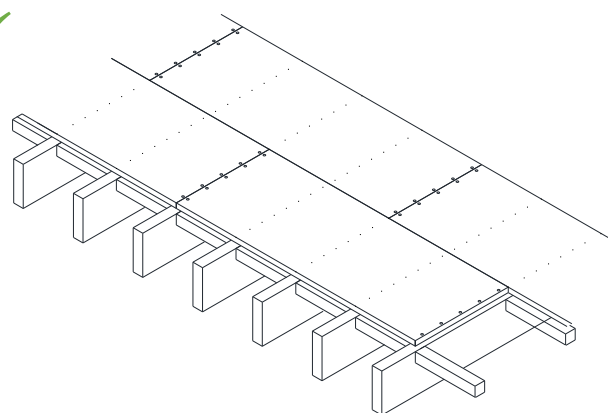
Cerramiento estructural a canto recto colocado perpendicularmente a las viguetas y apoyado sobre los travesaños o cubrejuntas. UNE ENV 12872
